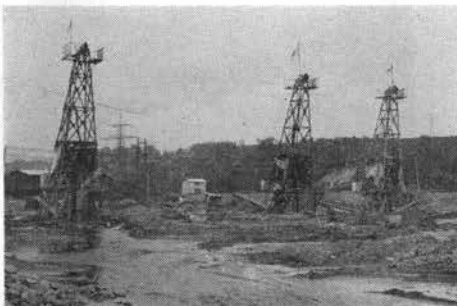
観別ダム堤体基礎止水工事の機械配置状況
